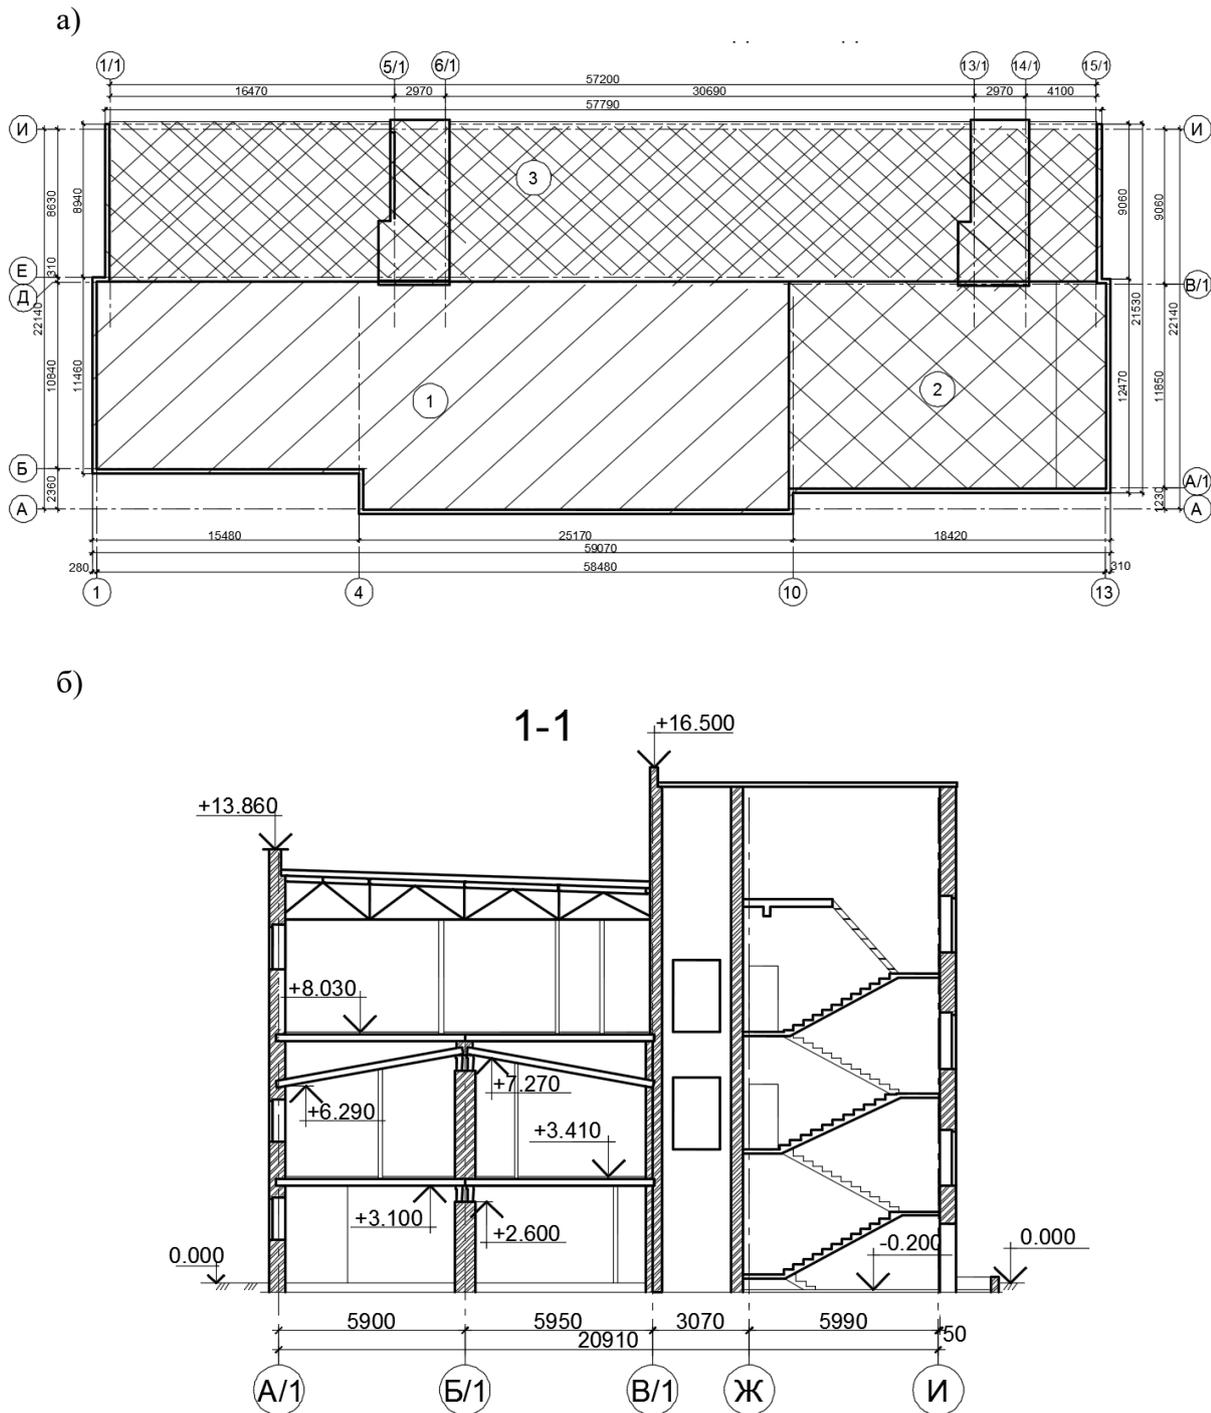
Конструктивная схема здания: а - схема плана первого этажа - 1- исходная часть здания с последующей надстройкой; 2- пристройка двухэтажной части с использованием сборных железобетонных плит перекрытия (впоследствии участок, на котором произошло обрушение); 3- трехэтажная пристройка; б – поперечный разрез
